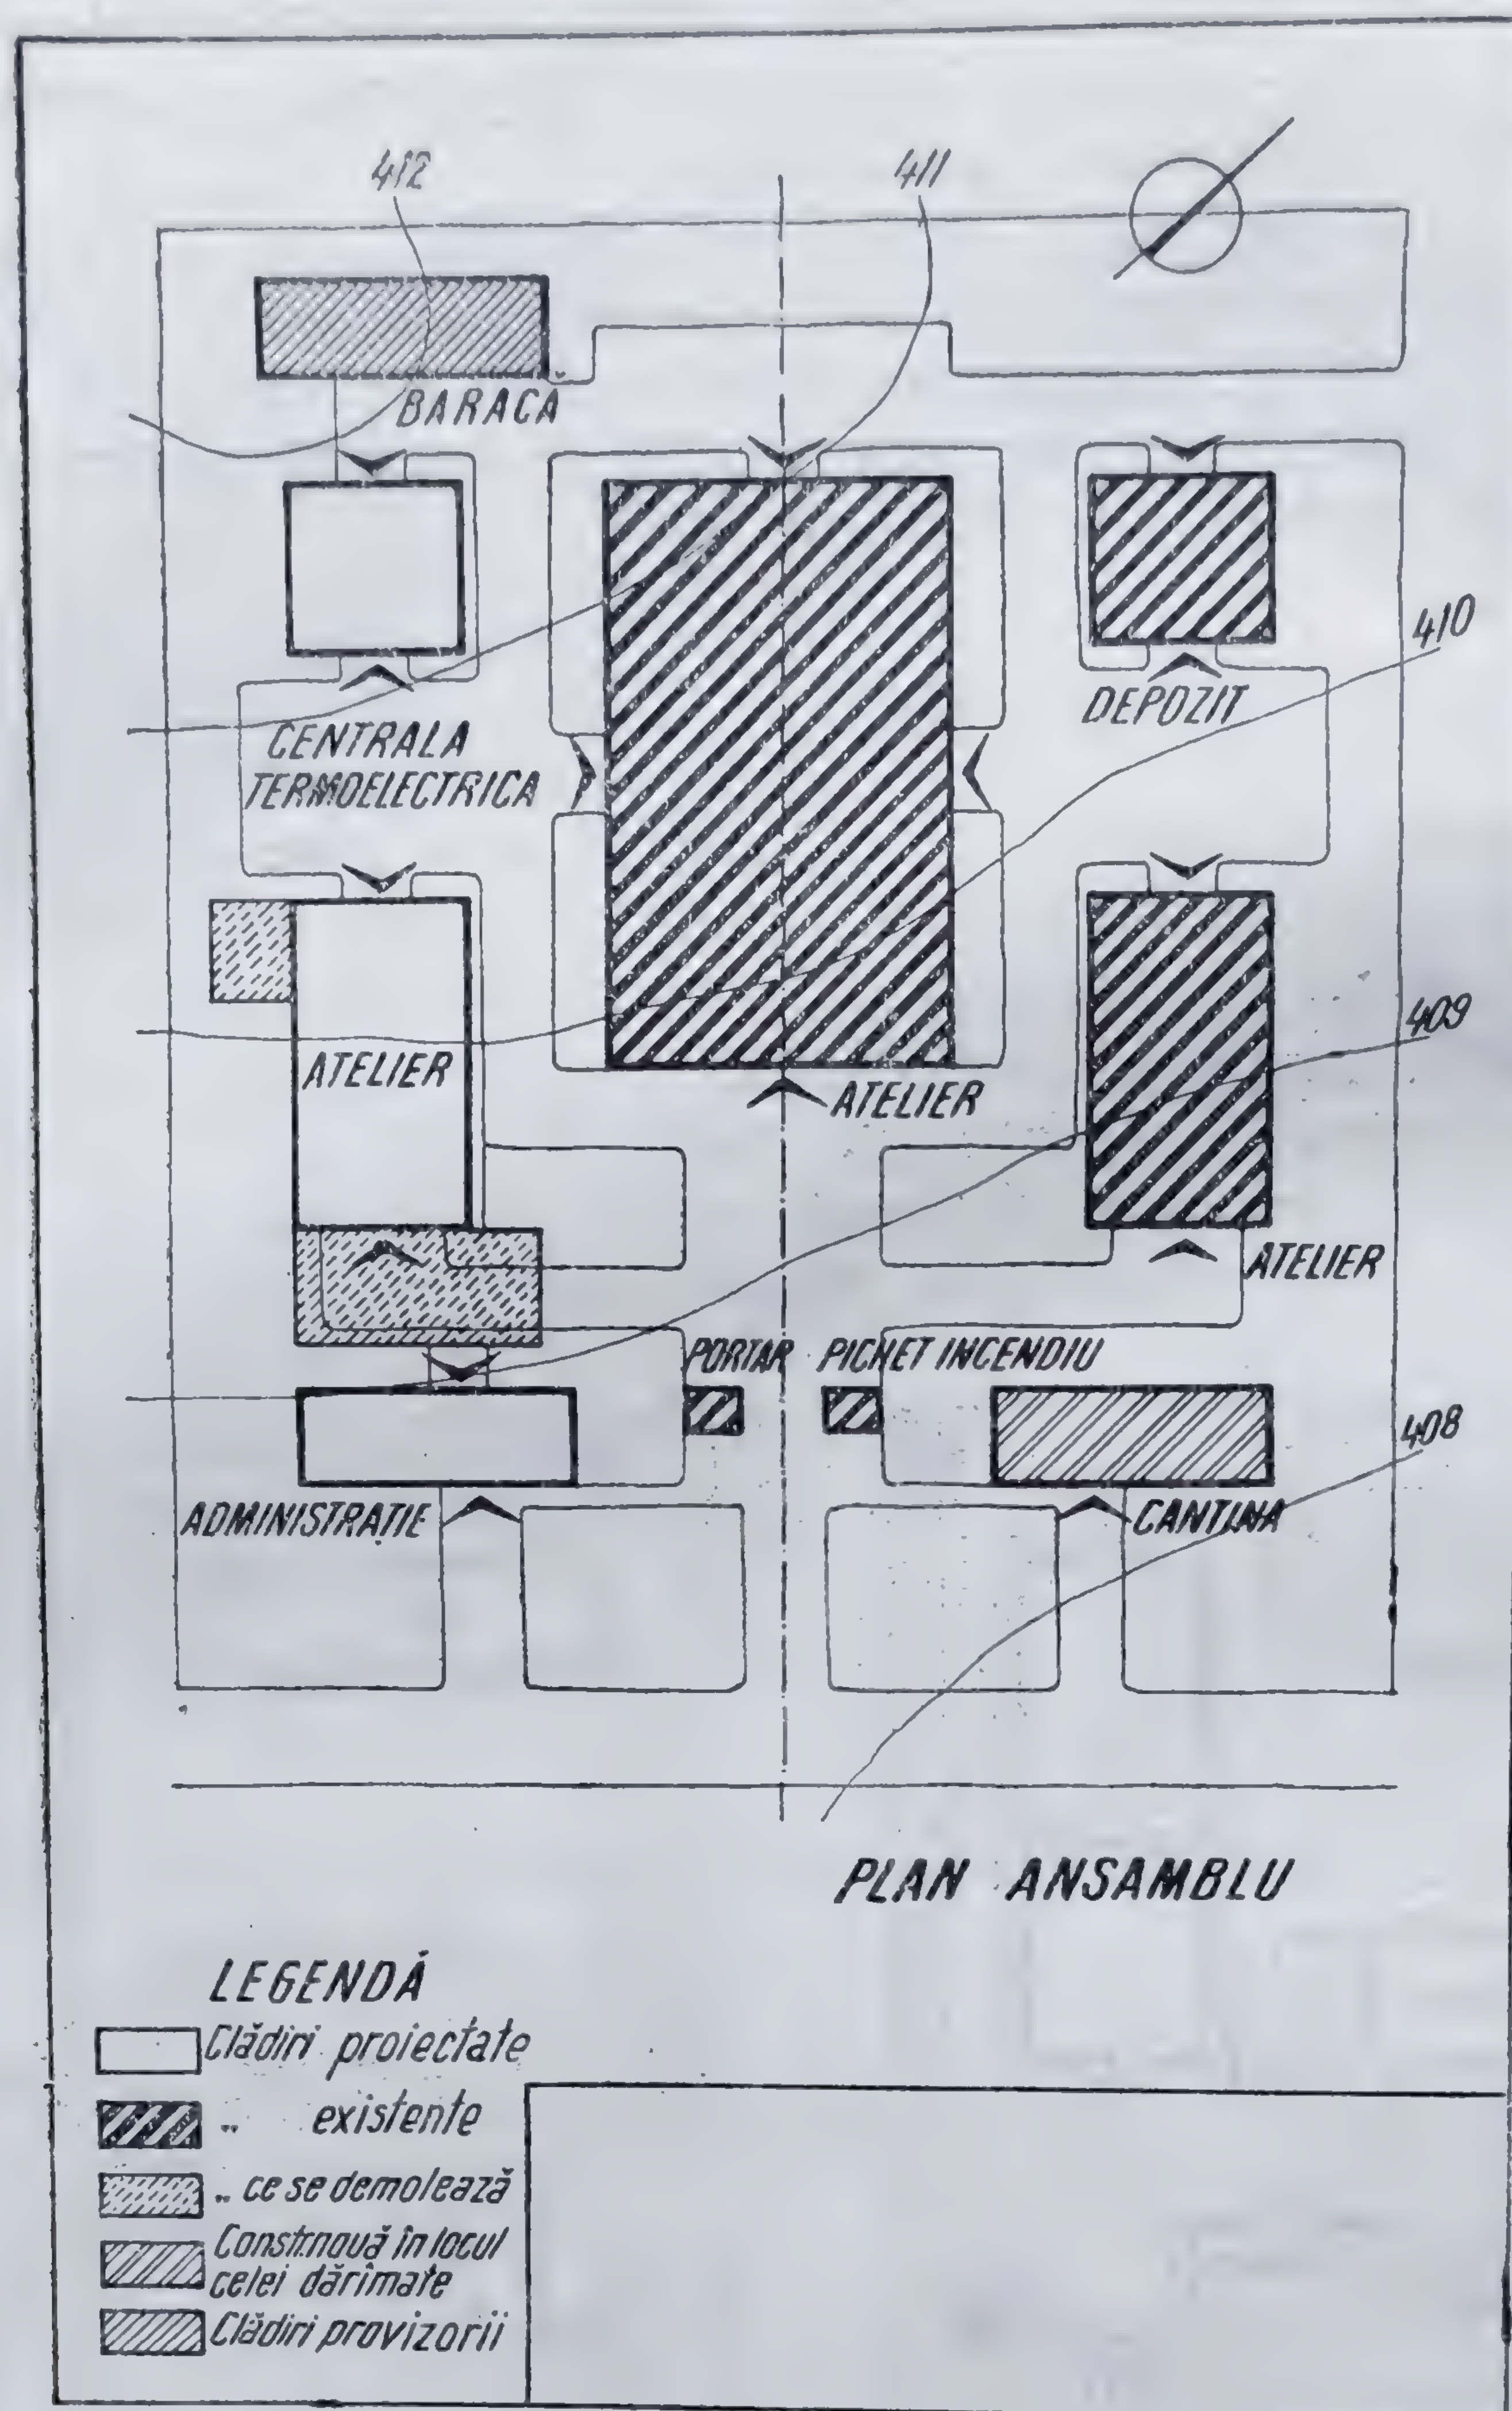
Desen pentru un plan de ansamblu cu construcții existente, dărâmări și construcții noi.
